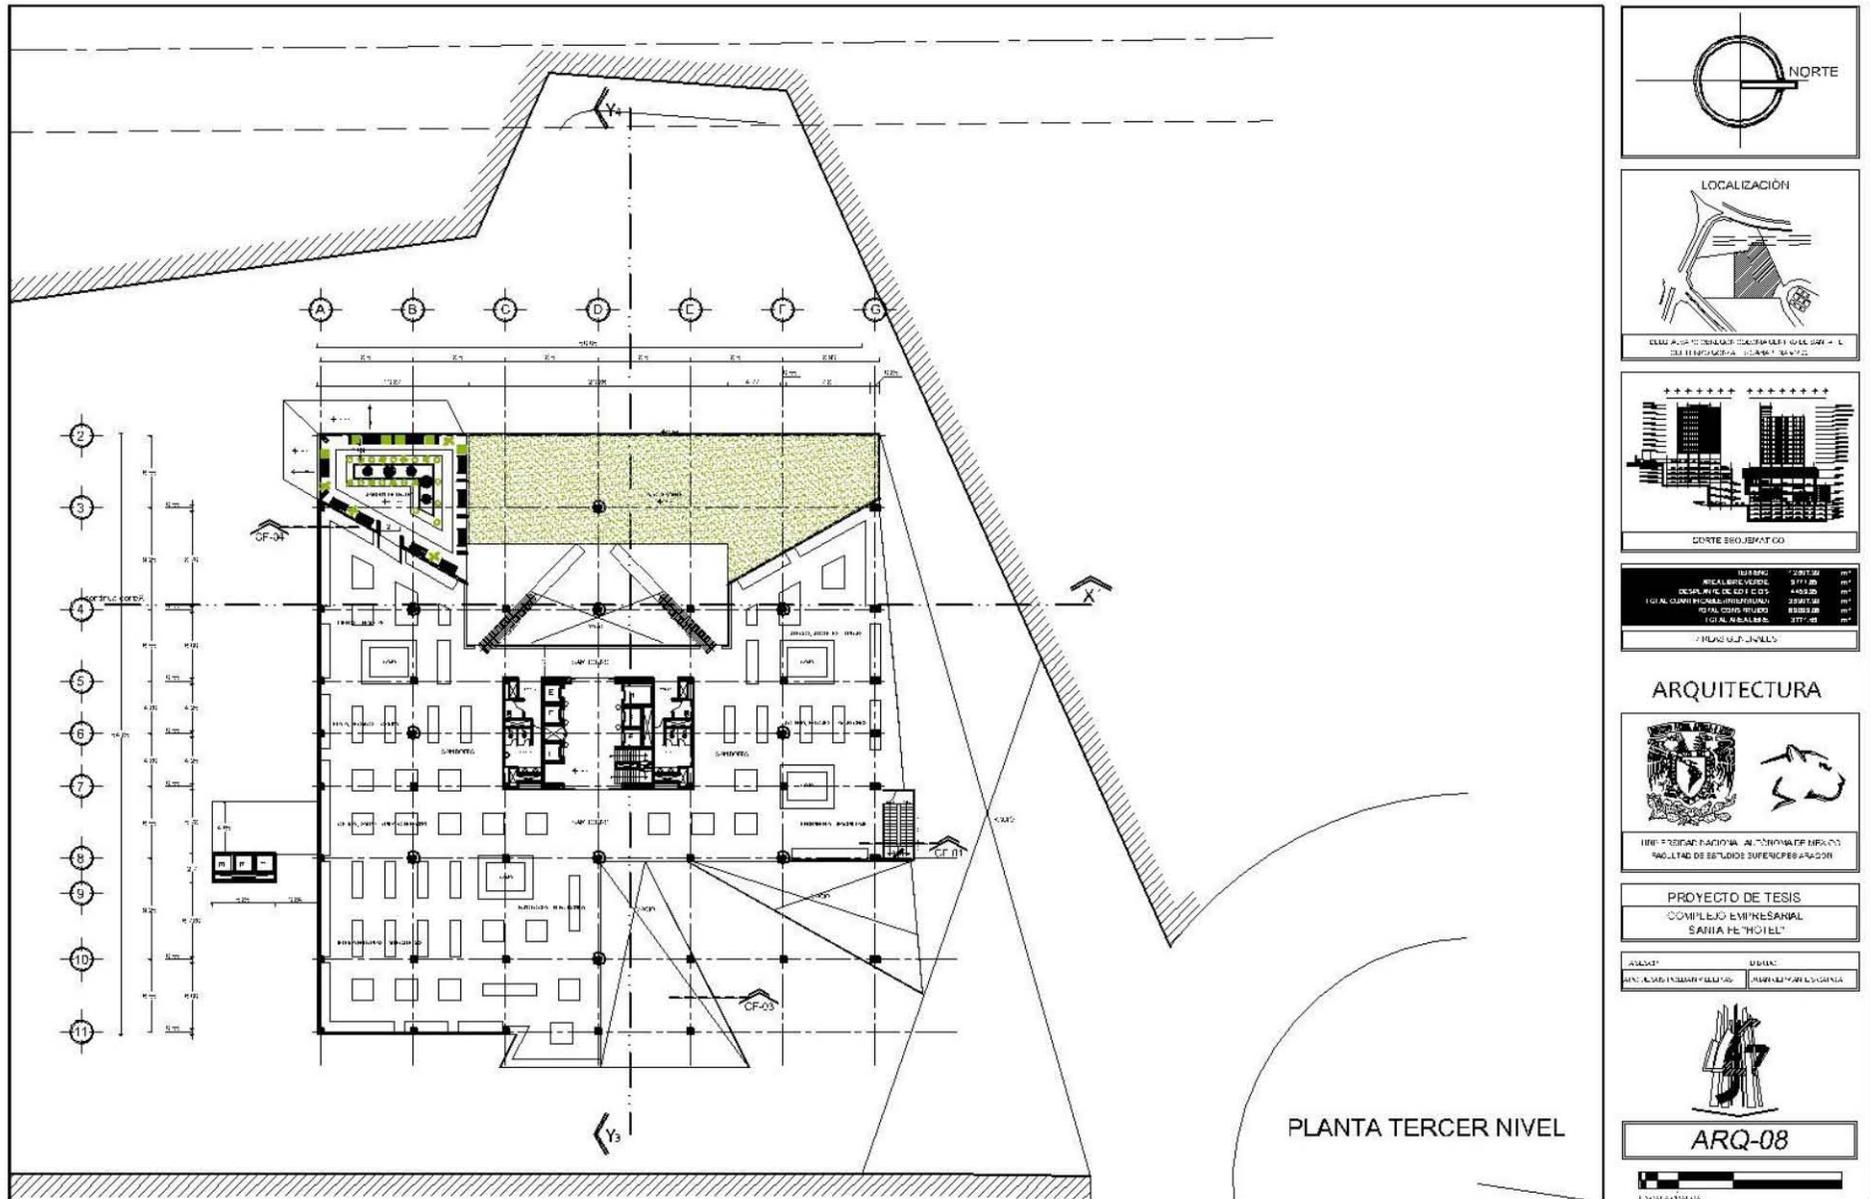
Plano ARQ-08; Planta Tercer Nivel Hotel/Centro Comercial. Edición propia.
